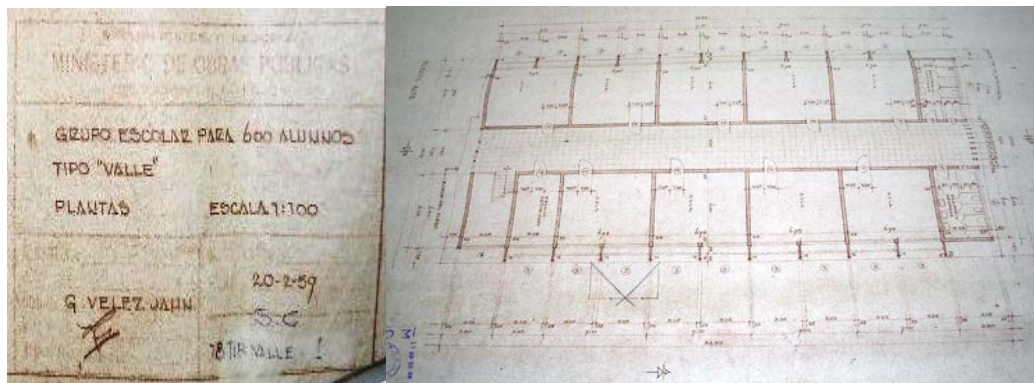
Plano de planta. Tipo Antiguo II
